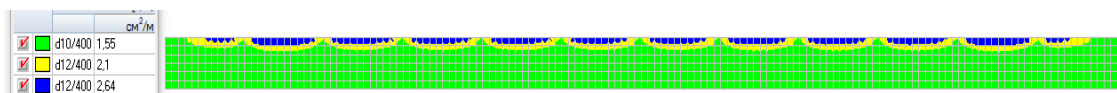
Армирование монолитных стен верхняя по y (комбинация нагрузок С1)
